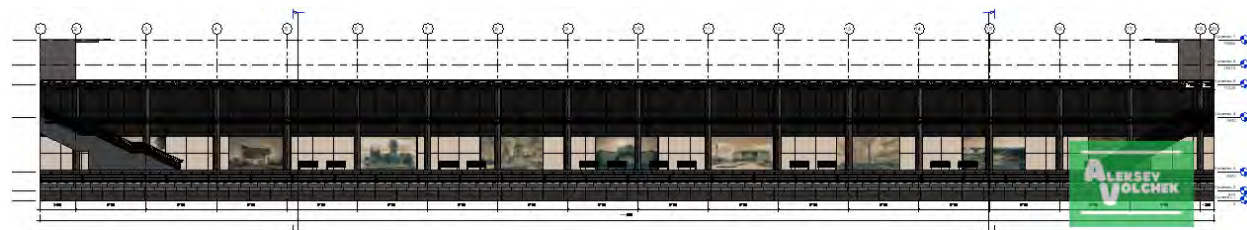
Продольный разрез 1-1 станции метрополитена
